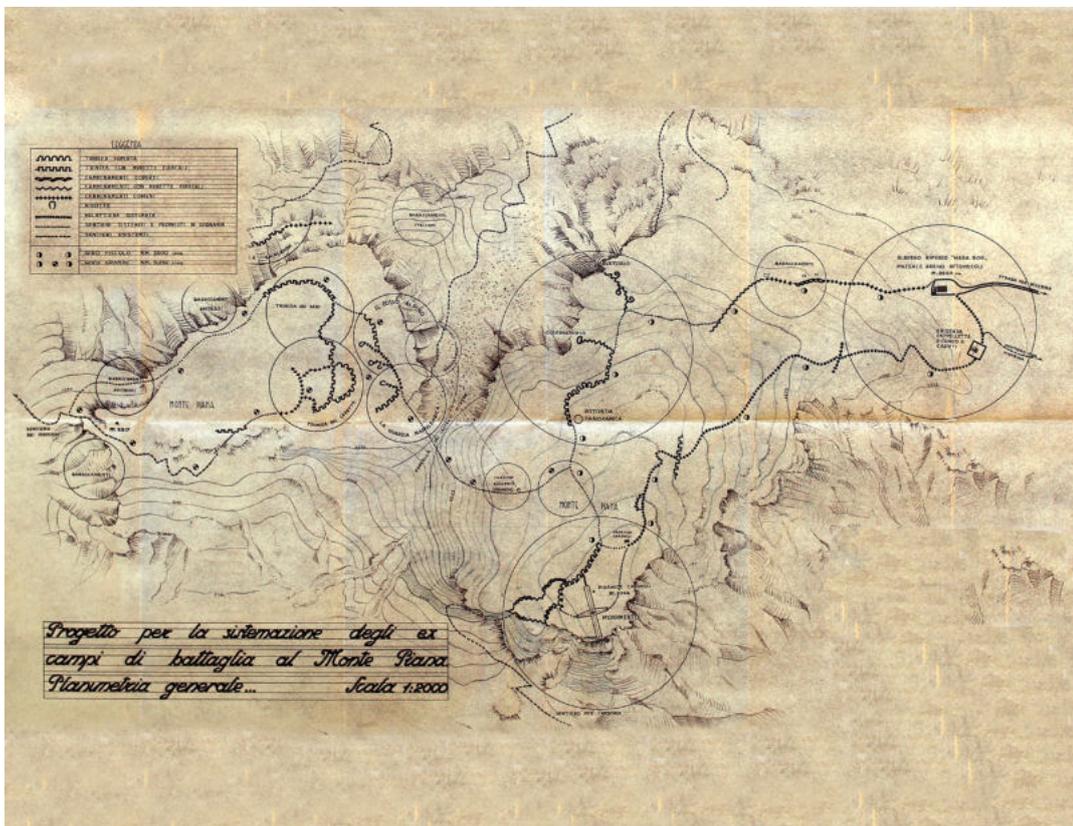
La planimetria alla scala 1/2000 con l'indicazione di tutte le opere progettate (Archivio Gurekian).
